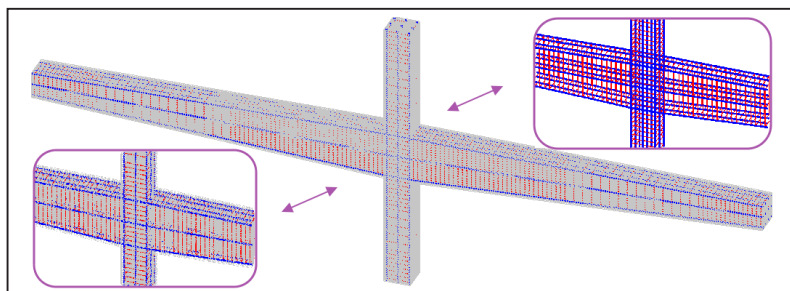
Варіант моделювання № 4 з додатковими поперечними та повздовжніми «арматурними» стержнями
